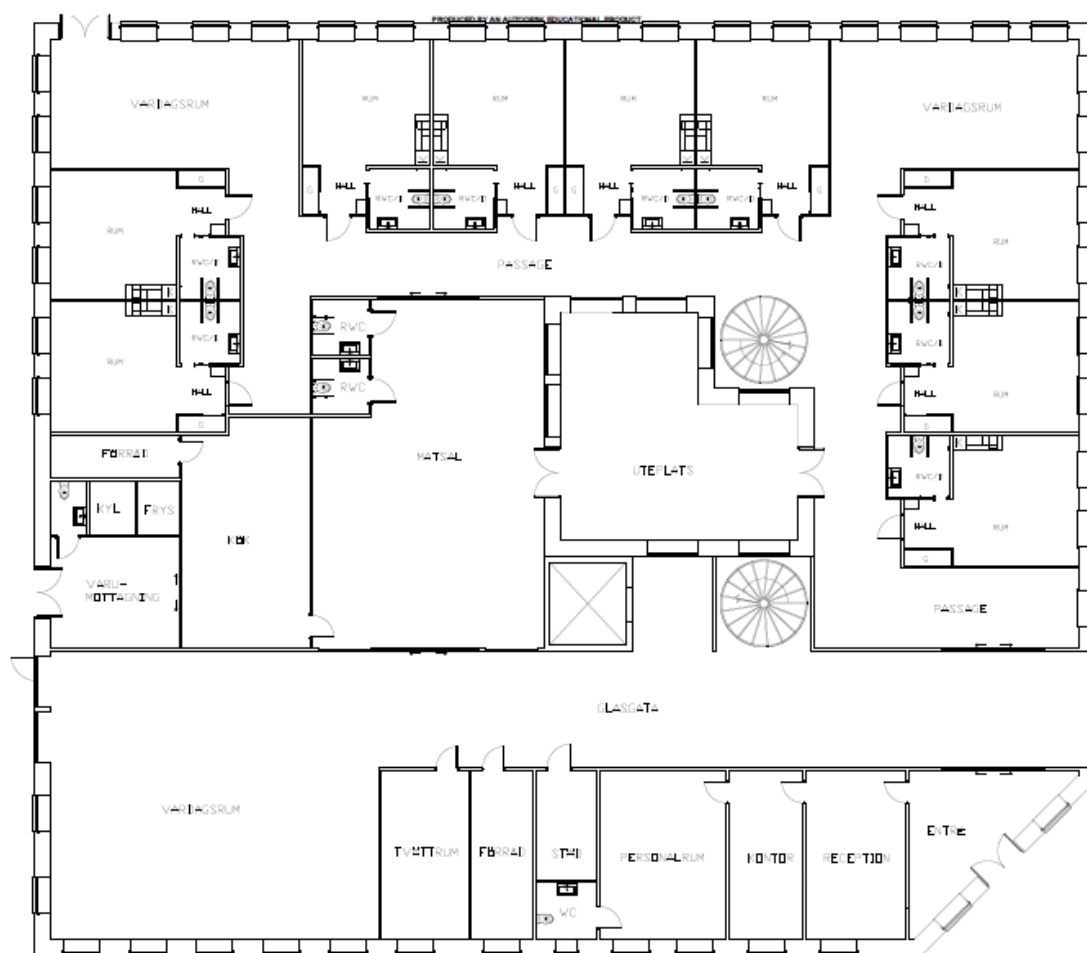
Vårdboende - Andra förslaget. Källarplan.
